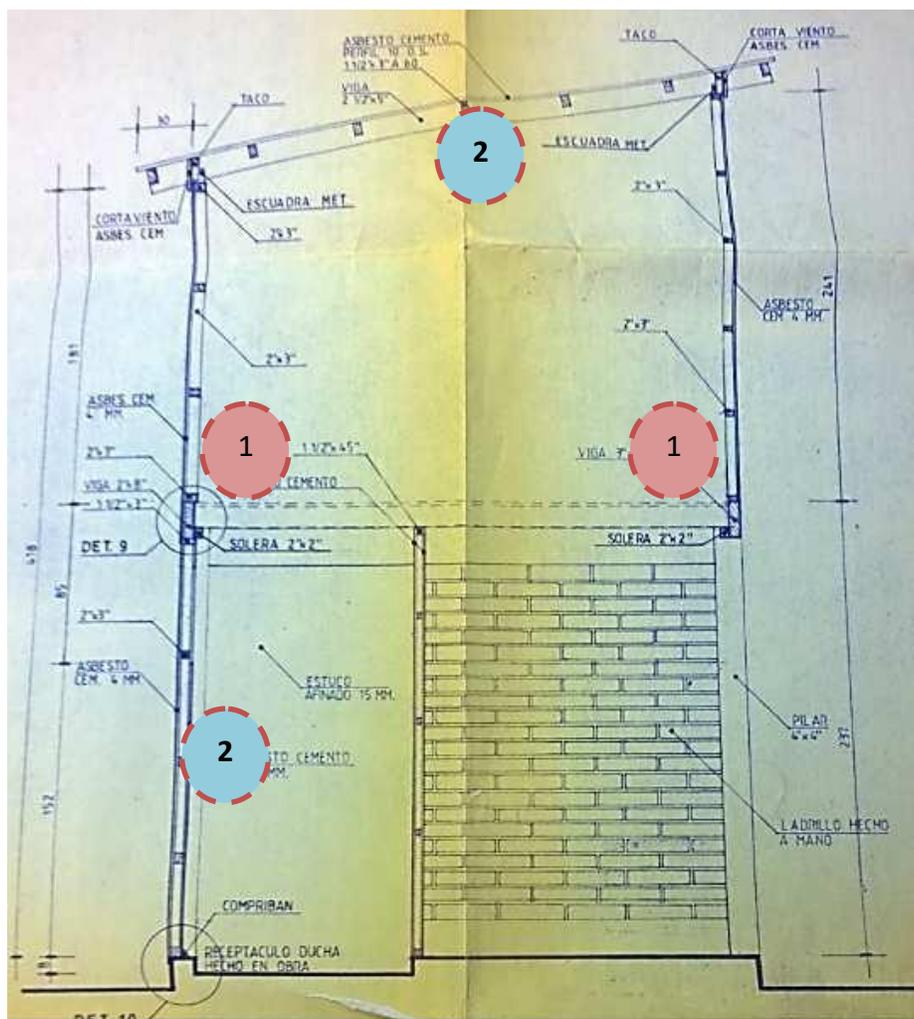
Corte o sección de vivienda tipo detalle de materiales implementados.
